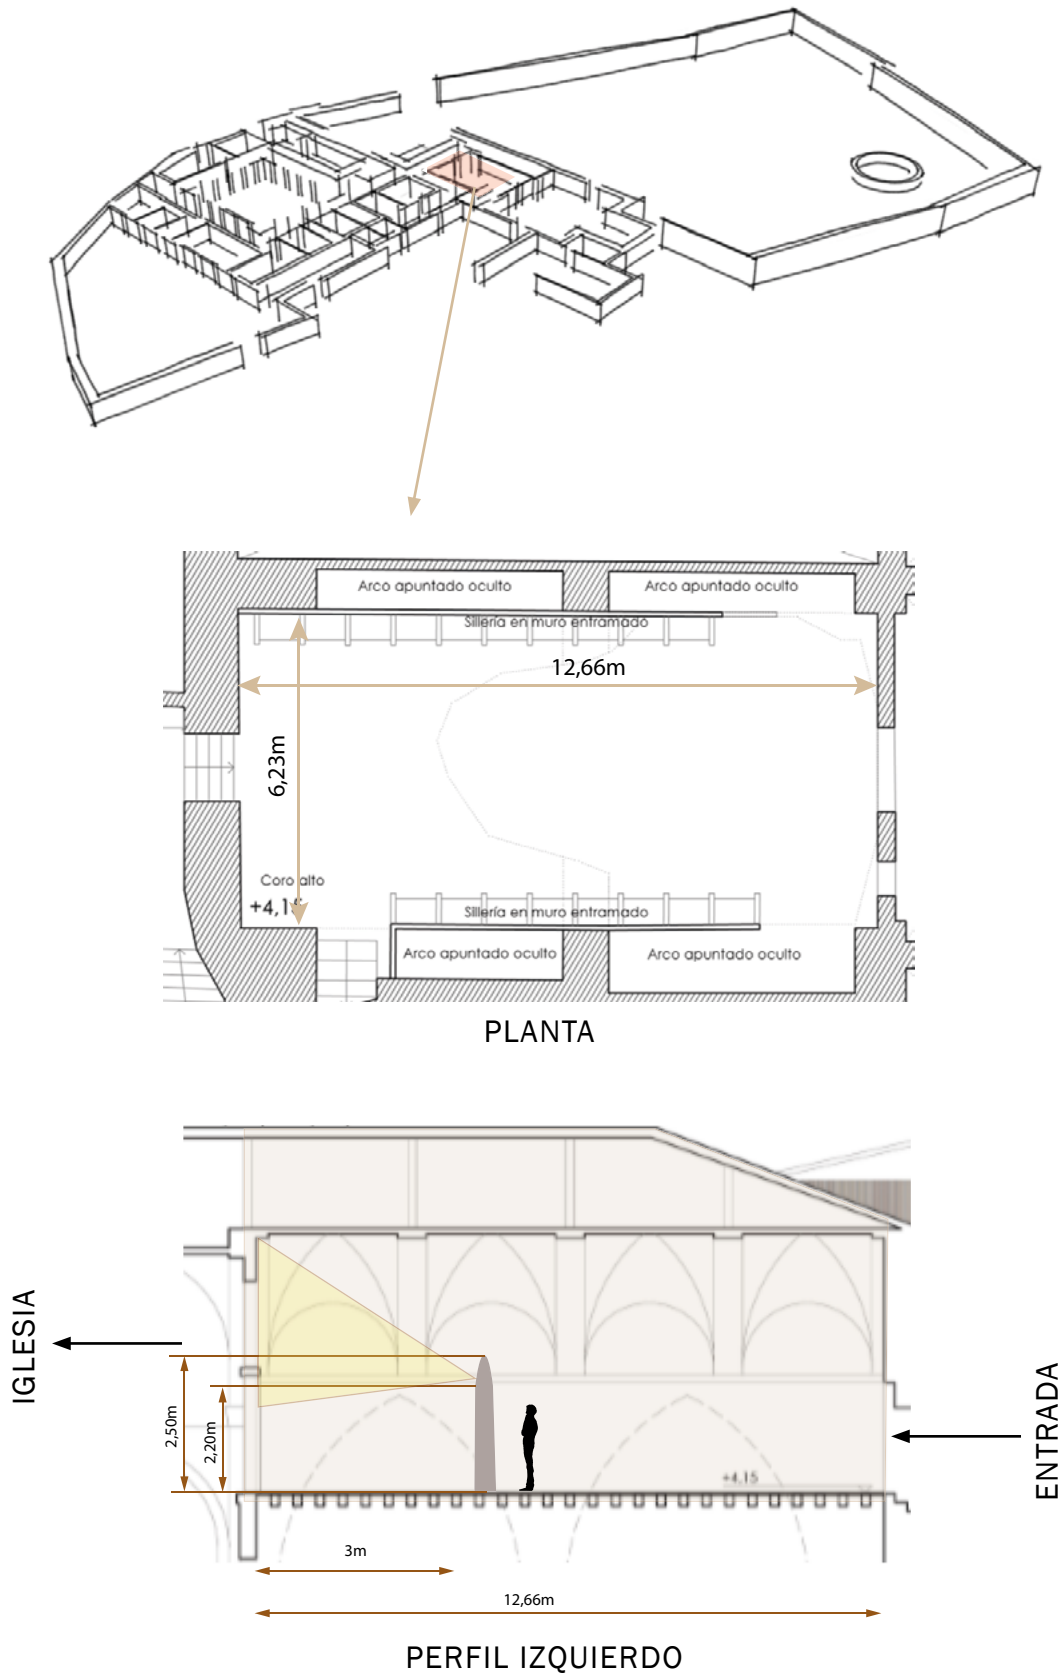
, 78 y 79: localización y medidas de la sala del alto, perfil y planta.
